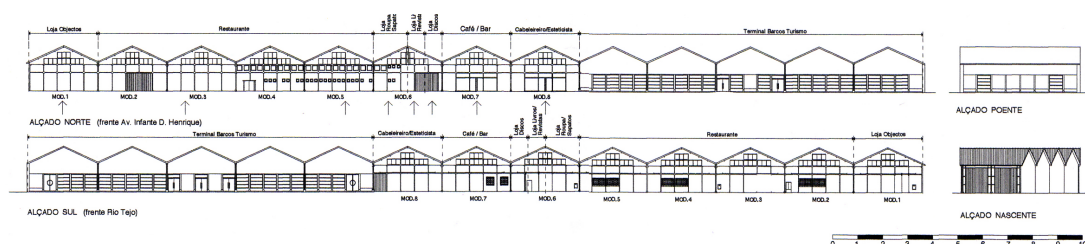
立面図 倉庫群のファサードは同一の建築事務所により決定された (下がテージョ川より見た立面図)
